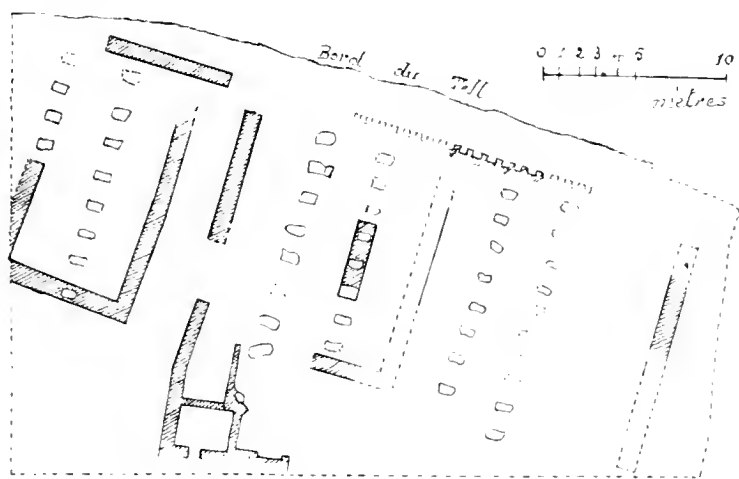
LACHIS. Construction à pilastres. D'après BLISS, *J. Monist.*, p. 91.
